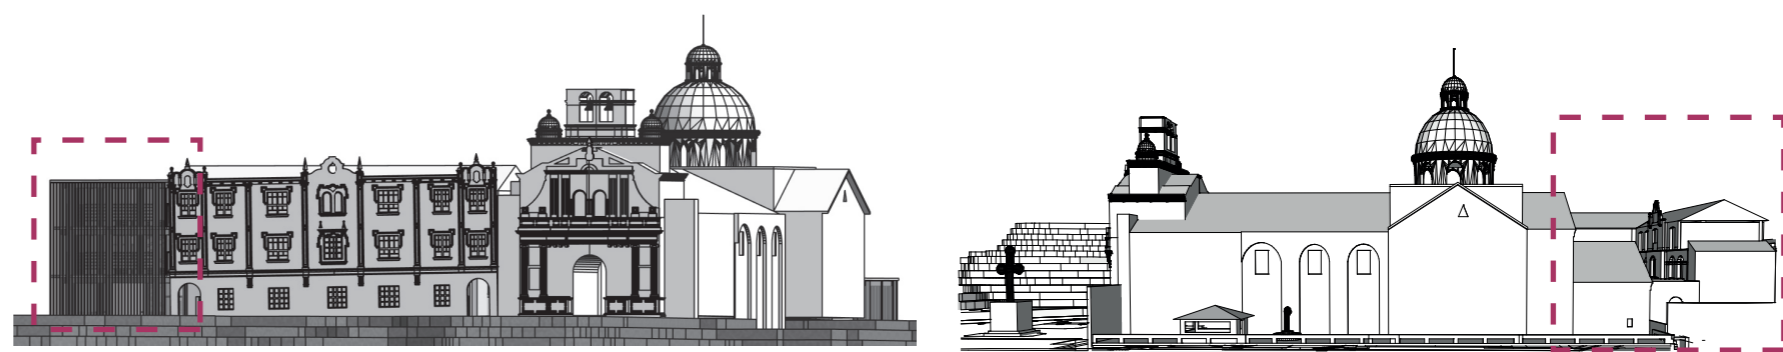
Amarrar las nuevas fachadas del proyecto a su preexistencia con armonía.
